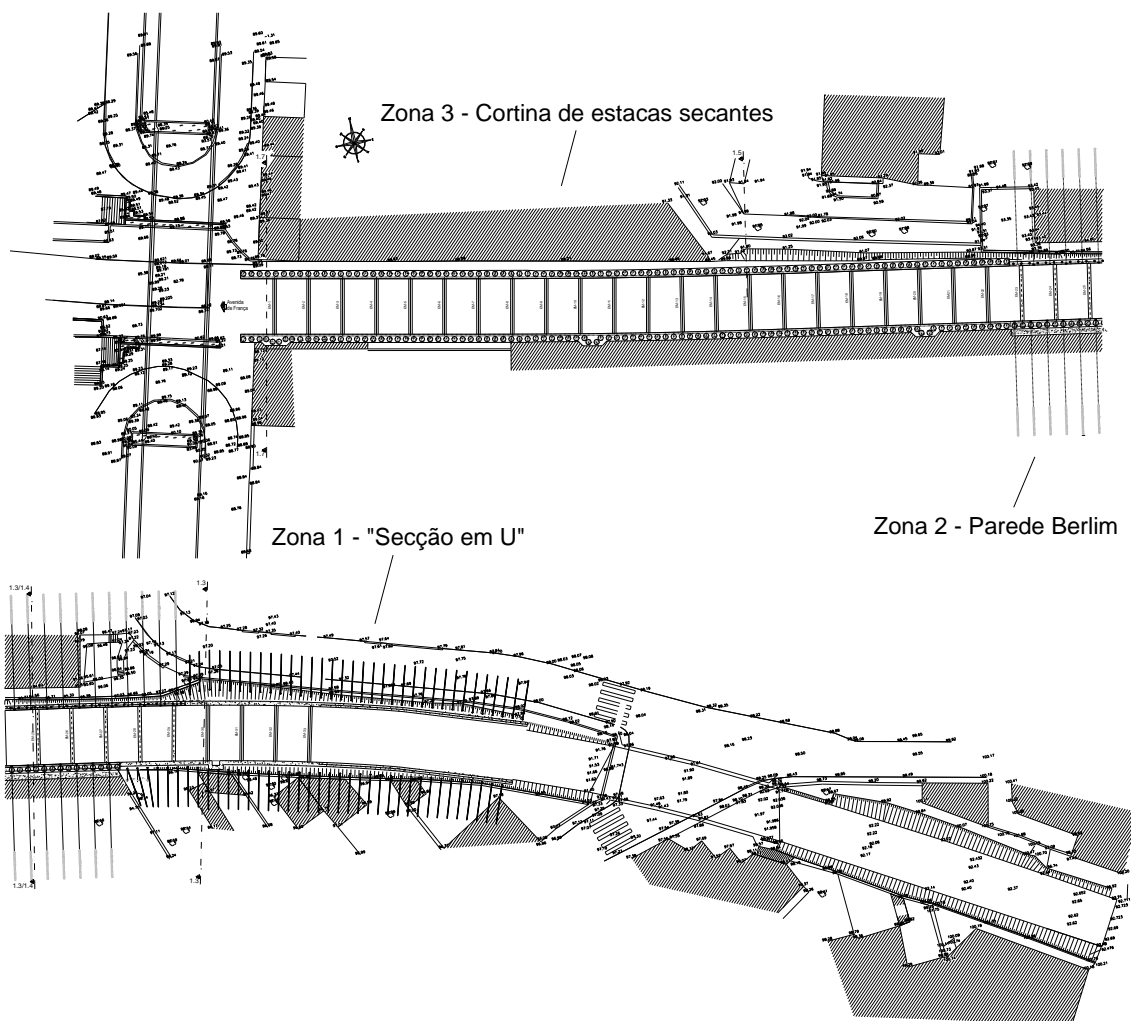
Planta estrutural de contenção da trincheira de acesso do lado Este à Estação da Casa da Música
